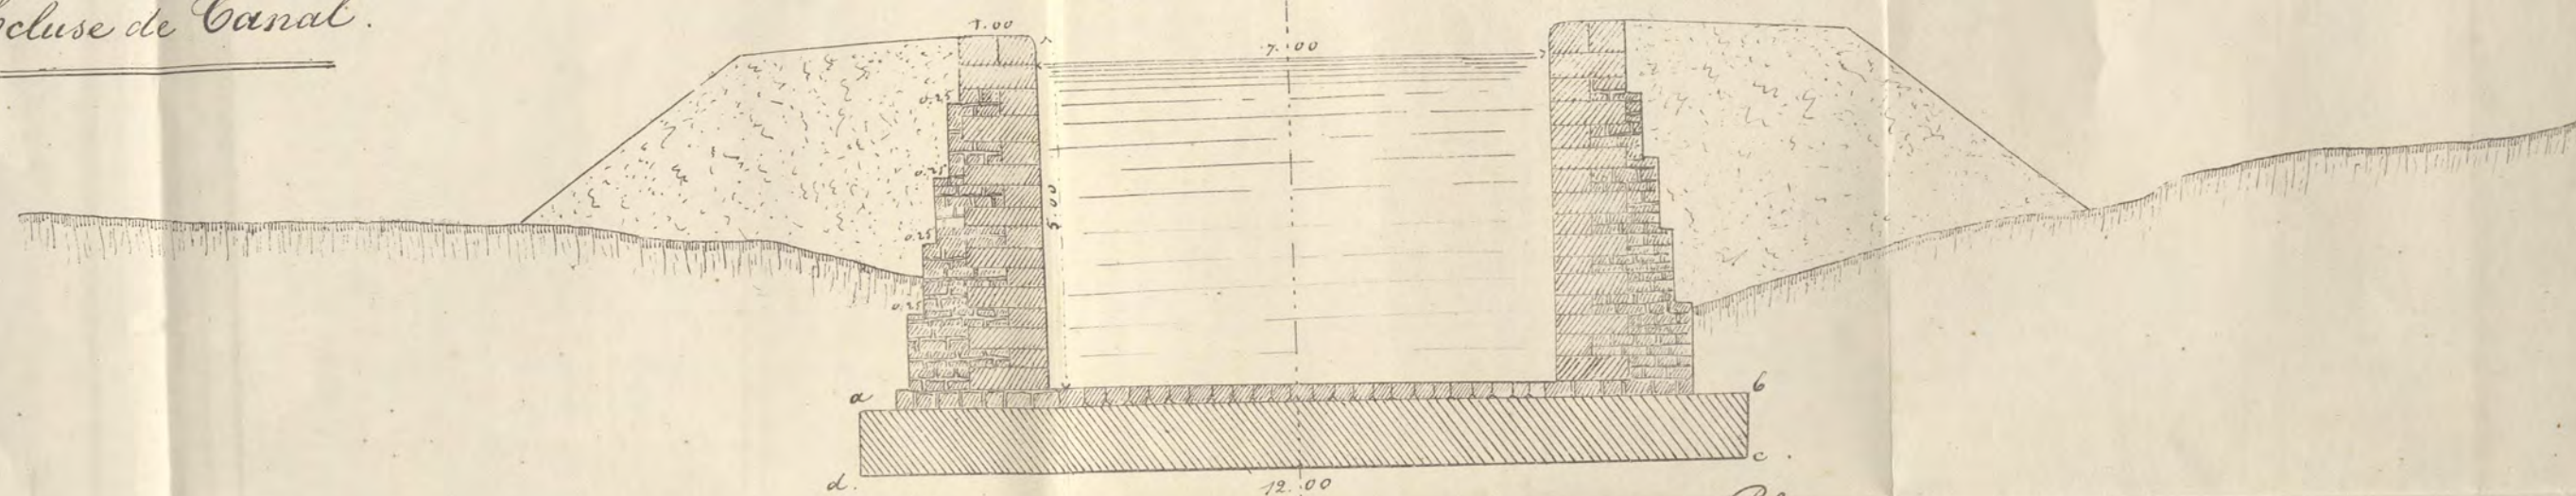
, Elevation et coupe en long suivant l'axe AB du Plan.
